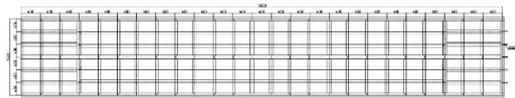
Design Layout Konstruksi Slope way Desain 2
